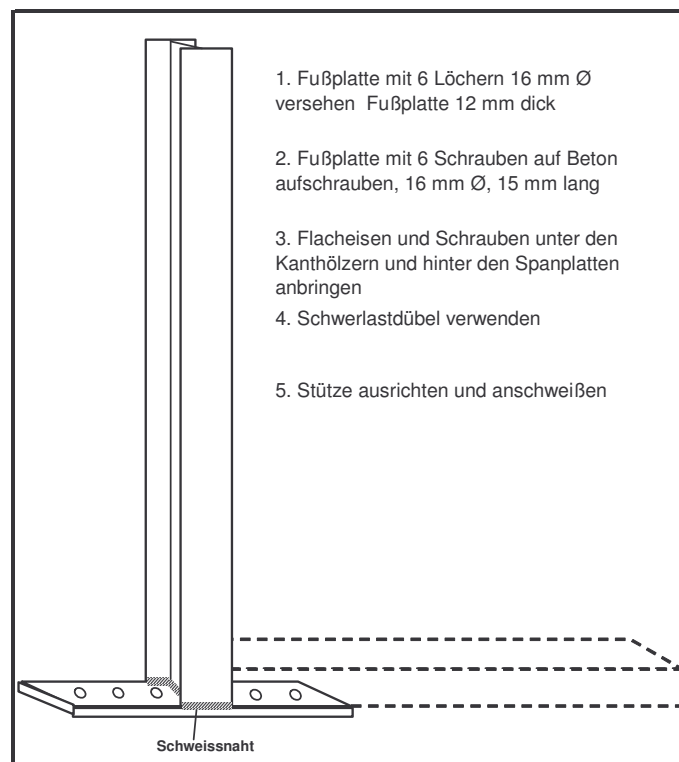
Flachlagerstütze mit Fußplatte zum Anschrauben.
